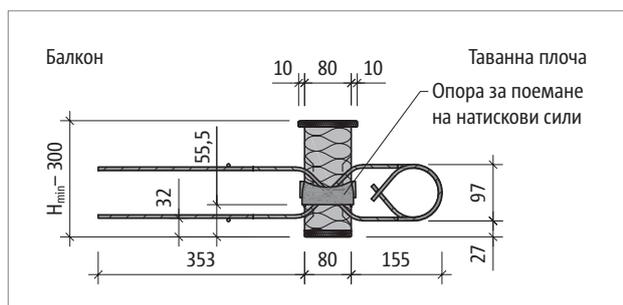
Schöck Isokorb® T мунове от QL-V2 до QL-V3: Сечение на продукта
